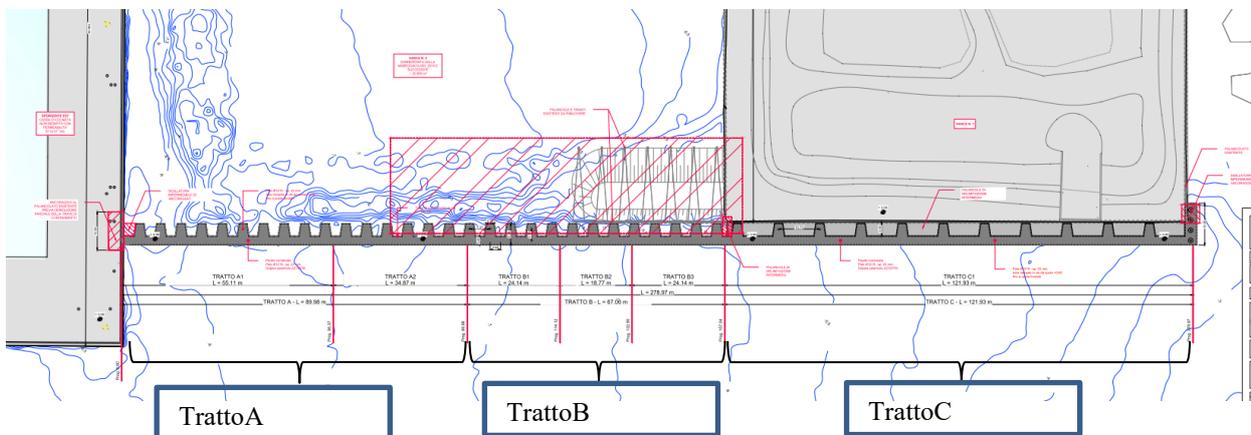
Planimetria generale di progetto (stralcio elaborato MI061P-PDDS4021)
